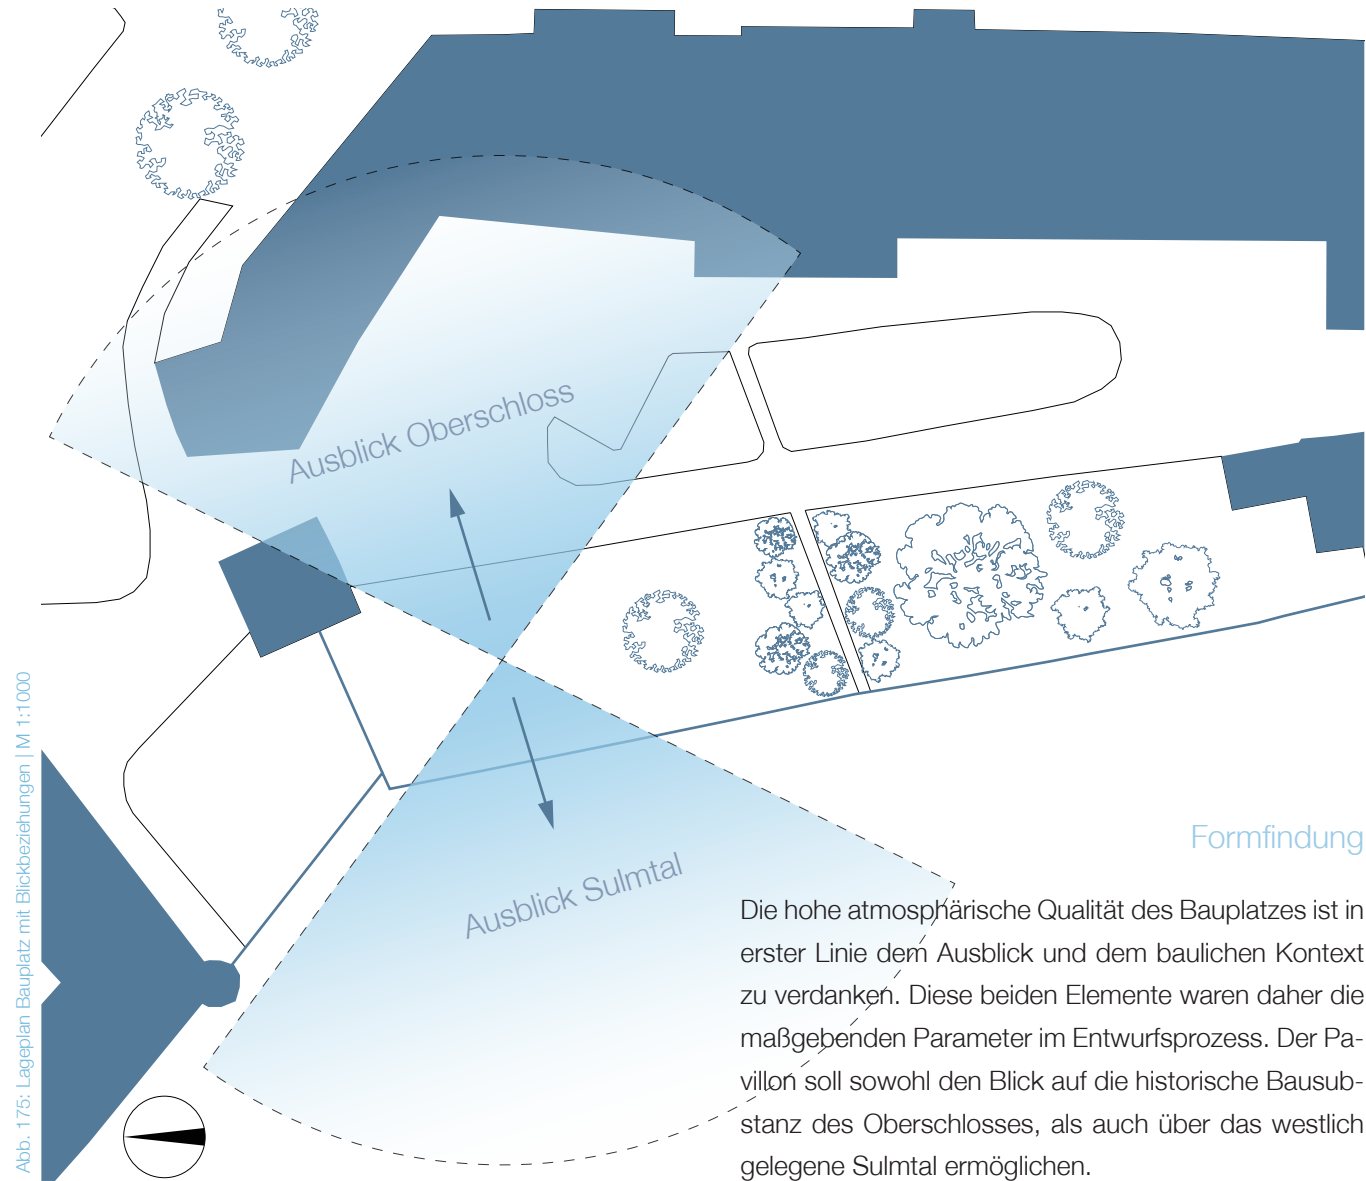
Lageplan Bauplatz mit Blickbeziehungen | M 1:1000
